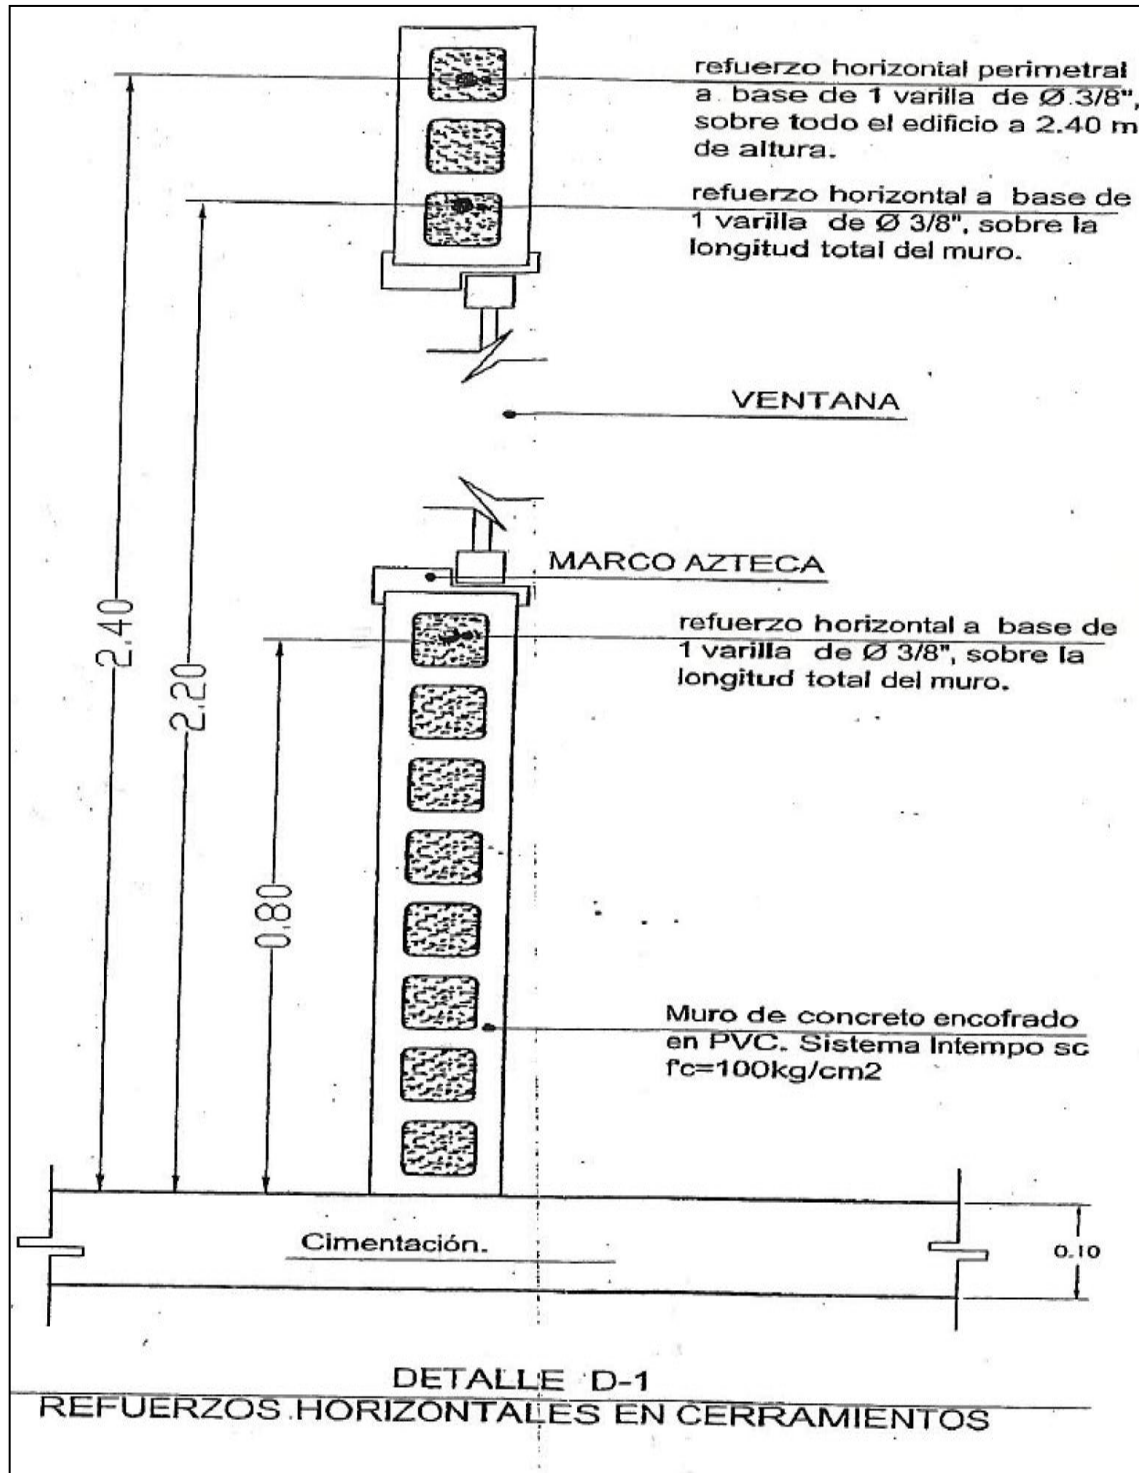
Detalle de refuerzo vertical y horizontal en muro
